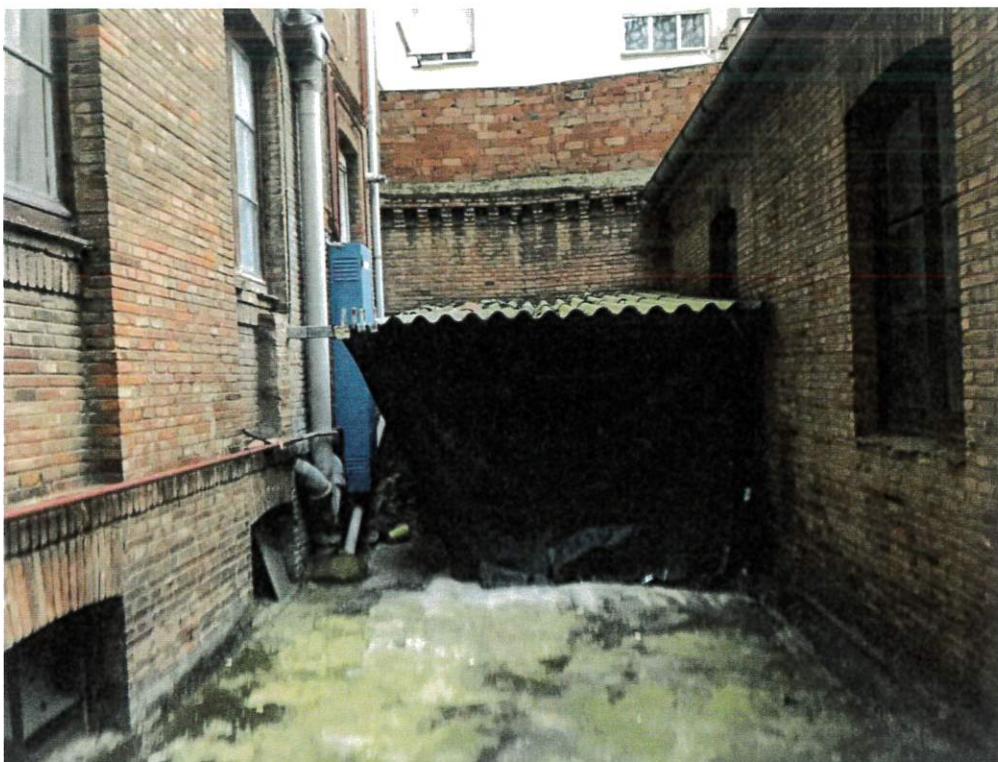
Fotografía de la construcción del cobertizo adosado a la fachada
